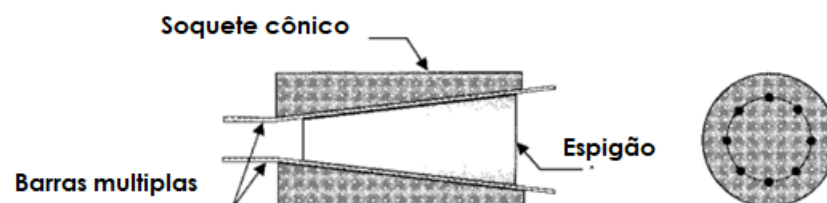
Ancoragem em Tampão e cone – adaptado [5]
